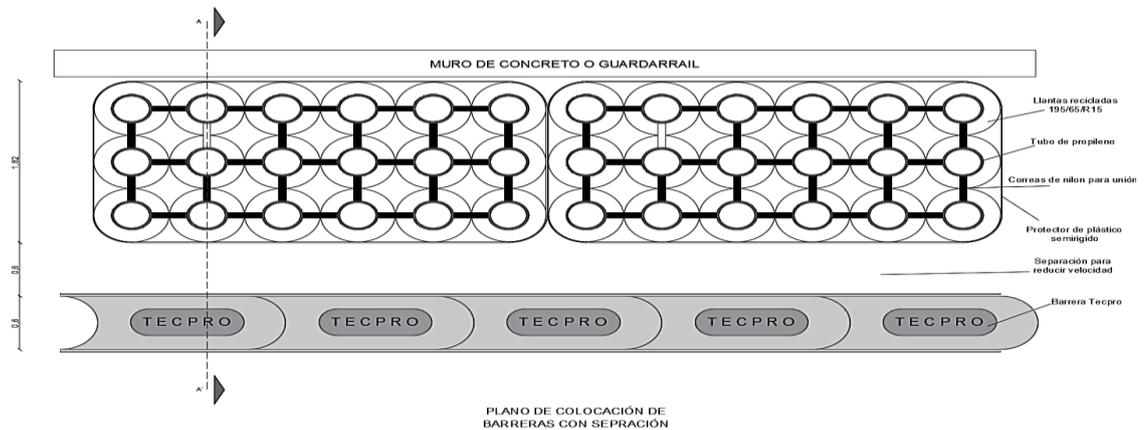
Fachadas de Detalle Barrera Tecpro
